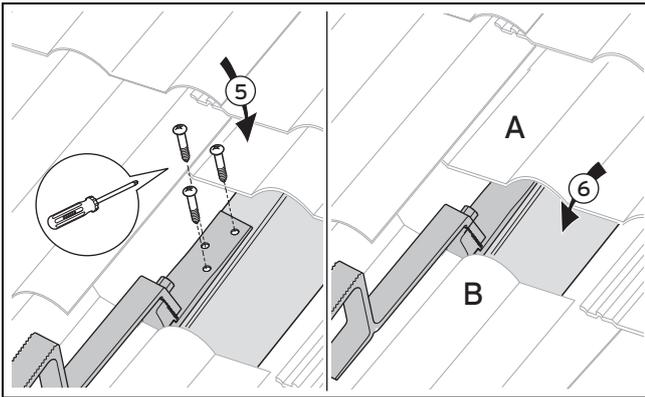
Dachanker Typ P auf dem Dachsparren befestigen
